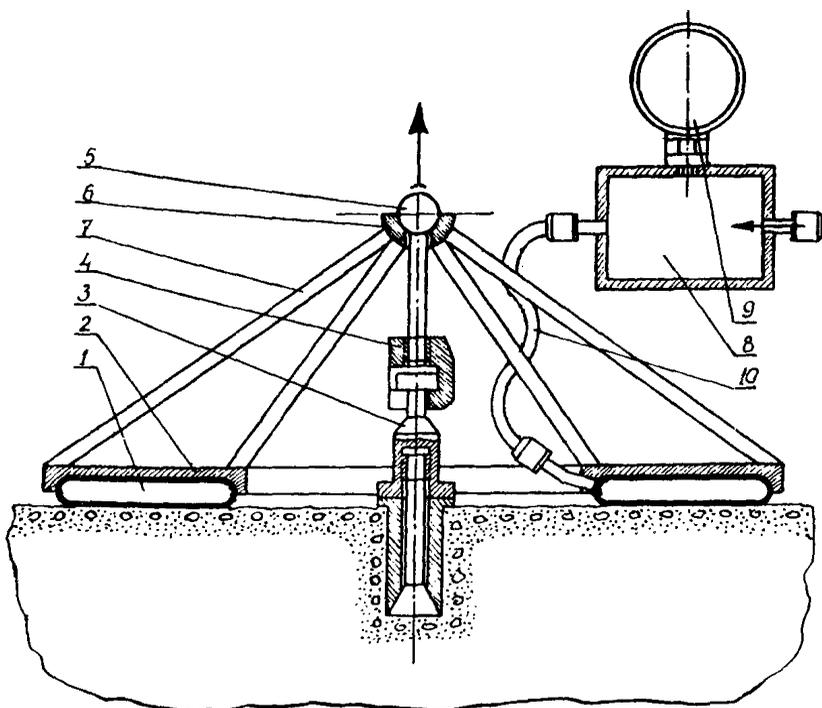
Схема устройства для испытаний бетона методом отрыва со скалыванием (с кольцевым домкратом): 1 - резиновая камера (от колеса мотороллера); 2 - опорное кольцо с ложем; 3 - анкер; 4 - захват анкера; 5 - тяга с шарниром; 6 - шарнирный упор; 7 - силовые стойки; 8 - ресивер; 9 - манометр; 10 - шланг насоса
